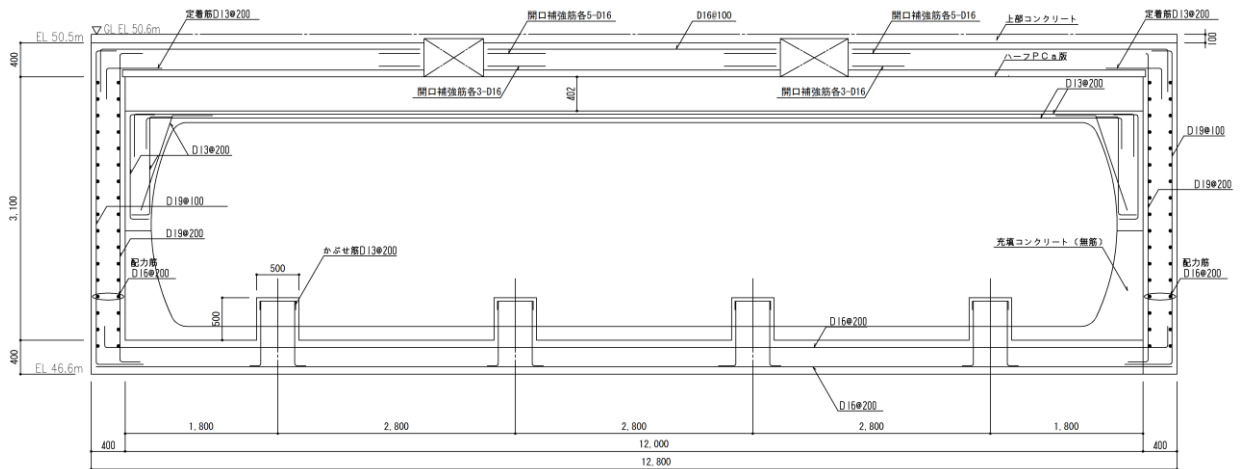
緊急時対策所用燃料地下タンク 概略配筋図 (A-A 断面)
